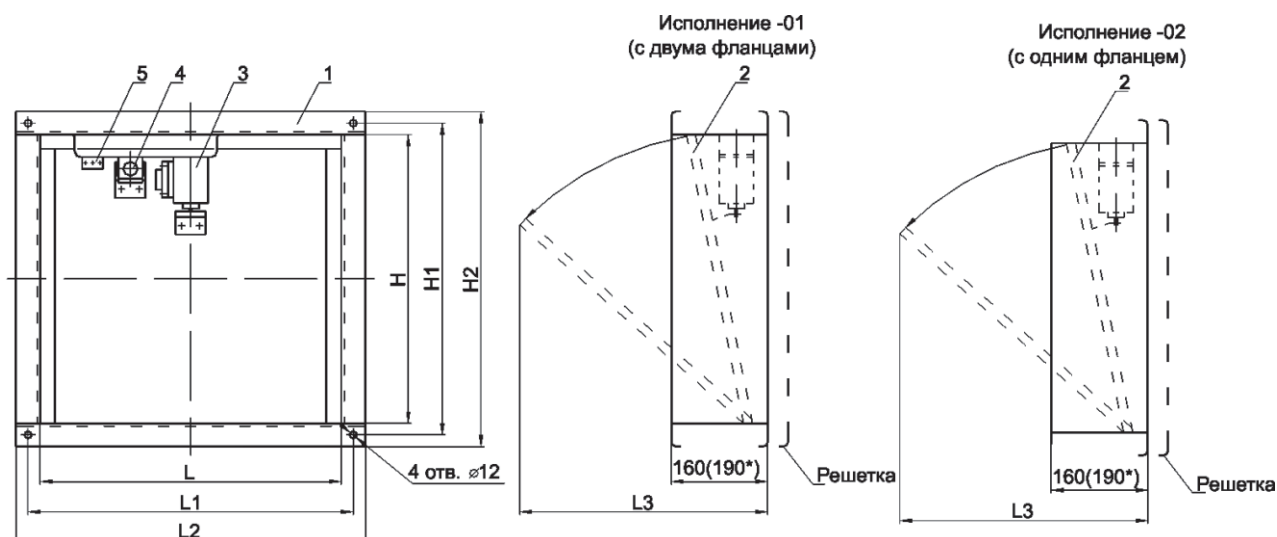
Габаритные и присоединительные размеры клапана дымоудаления КПДВ
